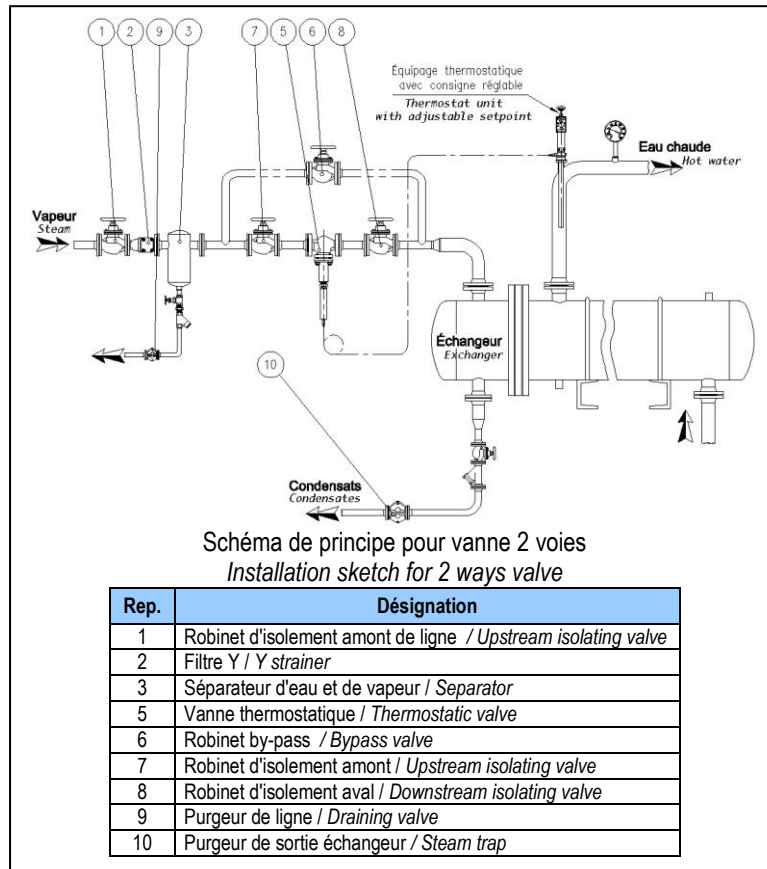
Schéma d'installation générale / *General installation sketch
